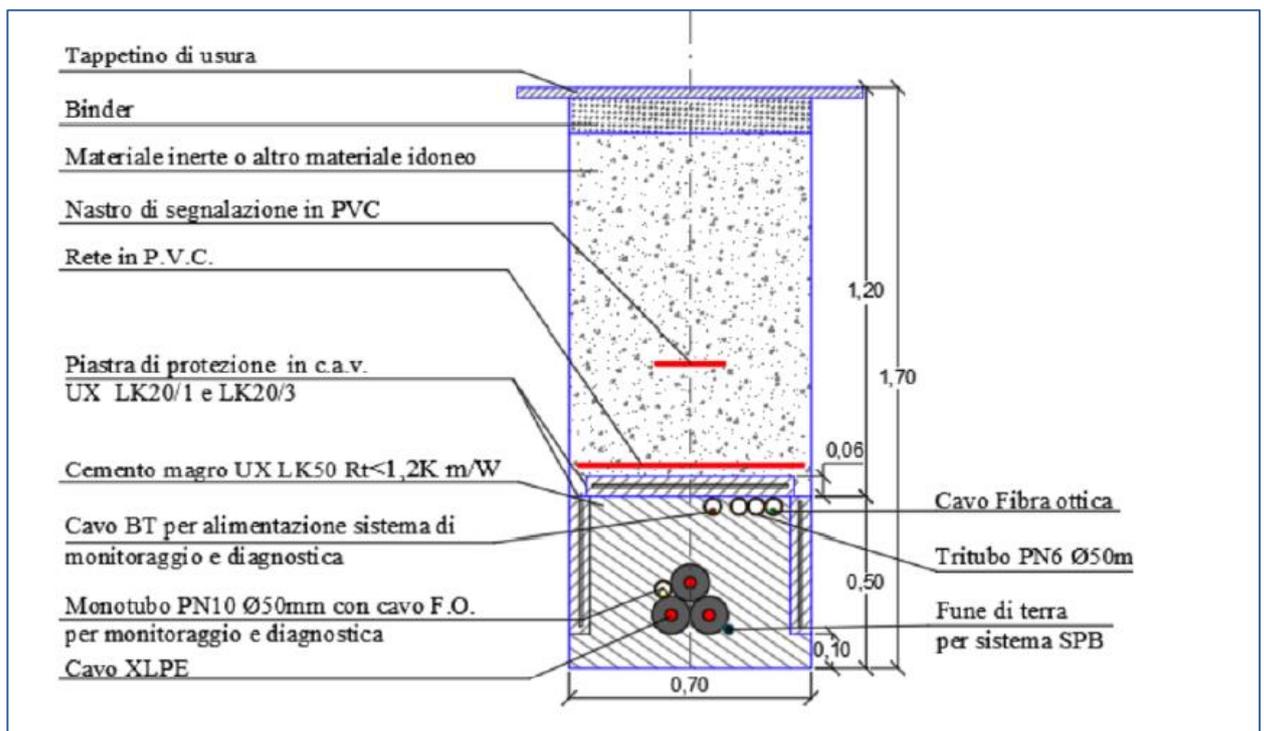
Sezione di posa del cavidotto AT su strada asfaltata
